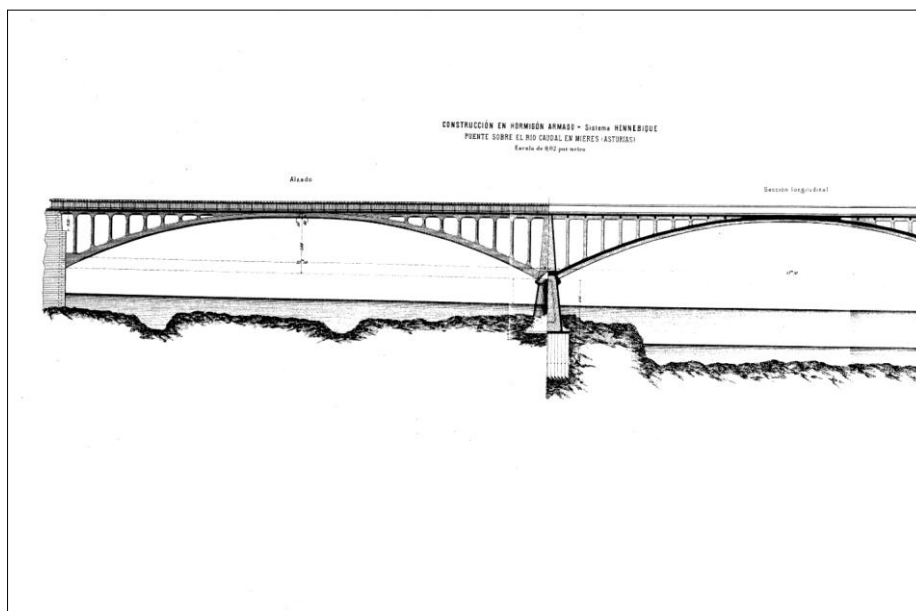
Proyecto de puente sobre el río Caudal publicado en la Revista de Obras Públicas
